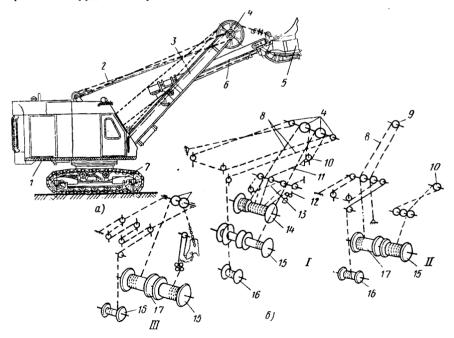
Экскаватор Э-652Б (а) и схема запасовки канатов рабочего оборудования (б): I — прямой лопаты; II — обратной лопаты; III — драглайна; I — поворотная платформа; 2 — поддерживающий канат; 3 — стрела; 4 — головные блоки; 5 — ковш; 6 — ружоять; 7 — гусеничный ход; 8 — подъемный канат; 9 — блоки рукояти; 10 — блок ковша; 11 — возвратный канат; 12 — механизм открывания днища ковша; 13 — напорный ка нат; 14 — напорный барабан; 15 — тяговый барабан; 16 — стрелоподъемный барабан; 17 - подъемный барабан
